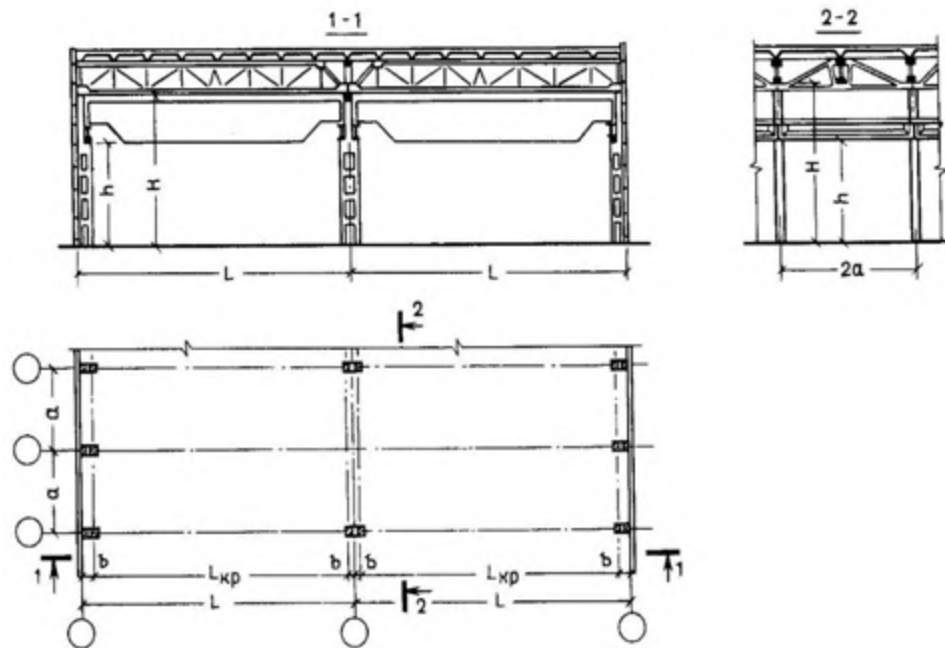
Основні об'ємно-планувальні параметрами промислової будівлі
